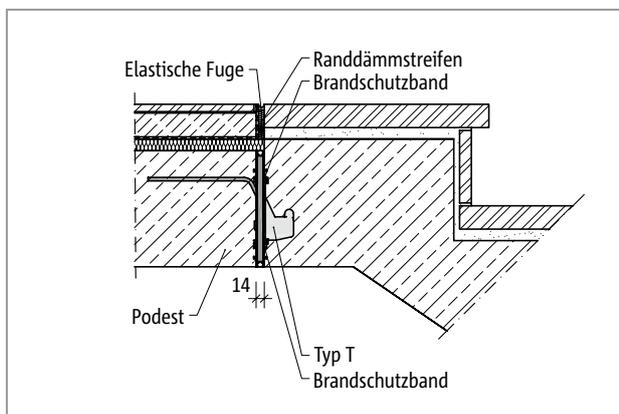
Schöck Tronsole® Typ T: Brandschutzausführung
